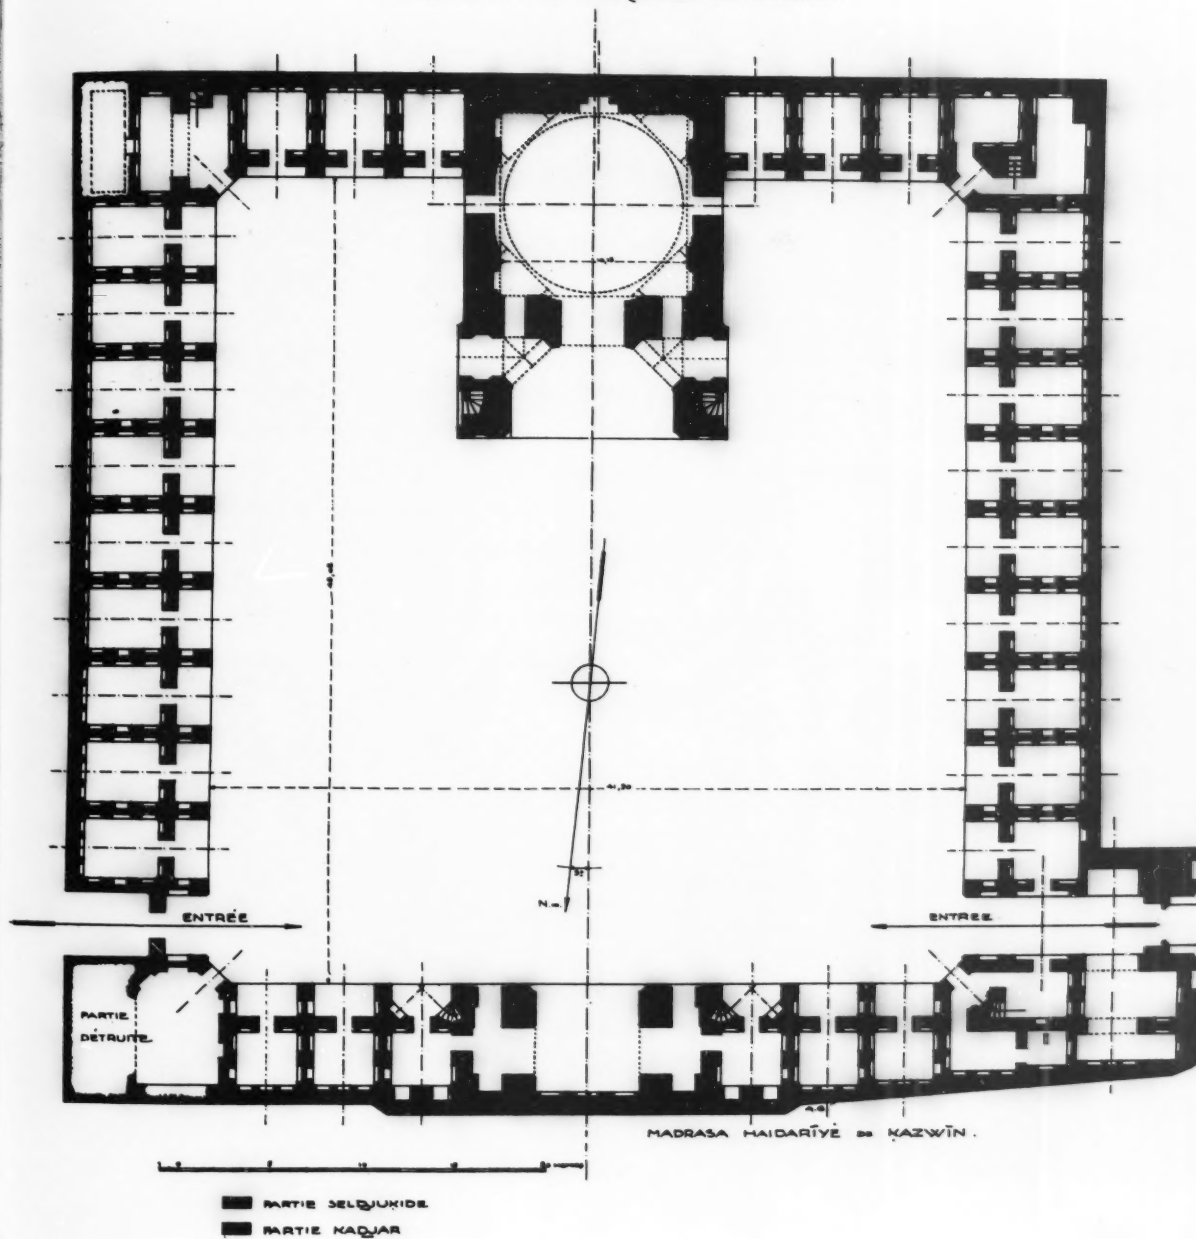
PLAN DE LA MADRASA HAIDARIYE
